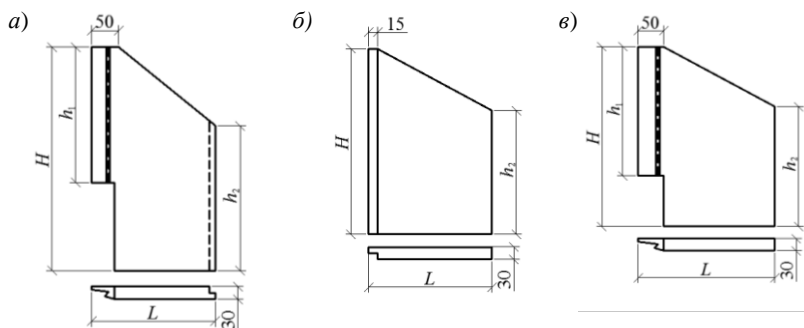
Откосные стенки для трубы водопропускной железобетонной прямоугольной сборной: а – откосные стенки марки СТ-1, СТ-2; б – откосная стенка марки СТ-3; в – откосная стенка марки СТ-4
